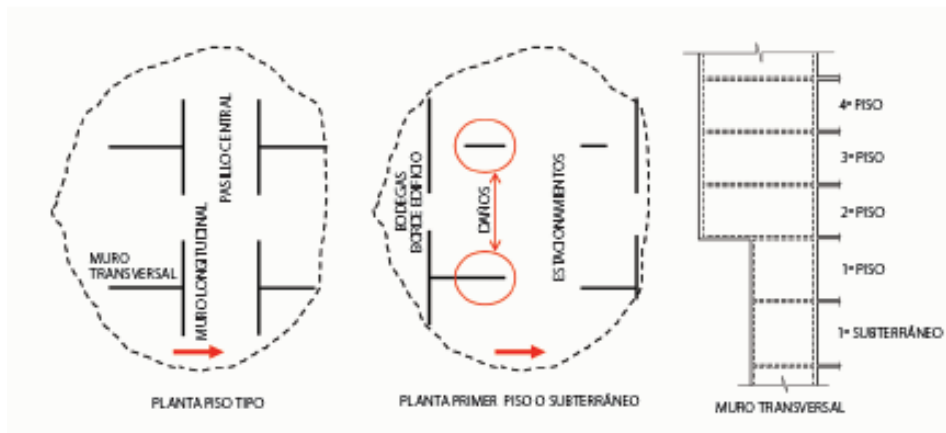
Configuración estructural primer piso y primer subterráneo [10]
